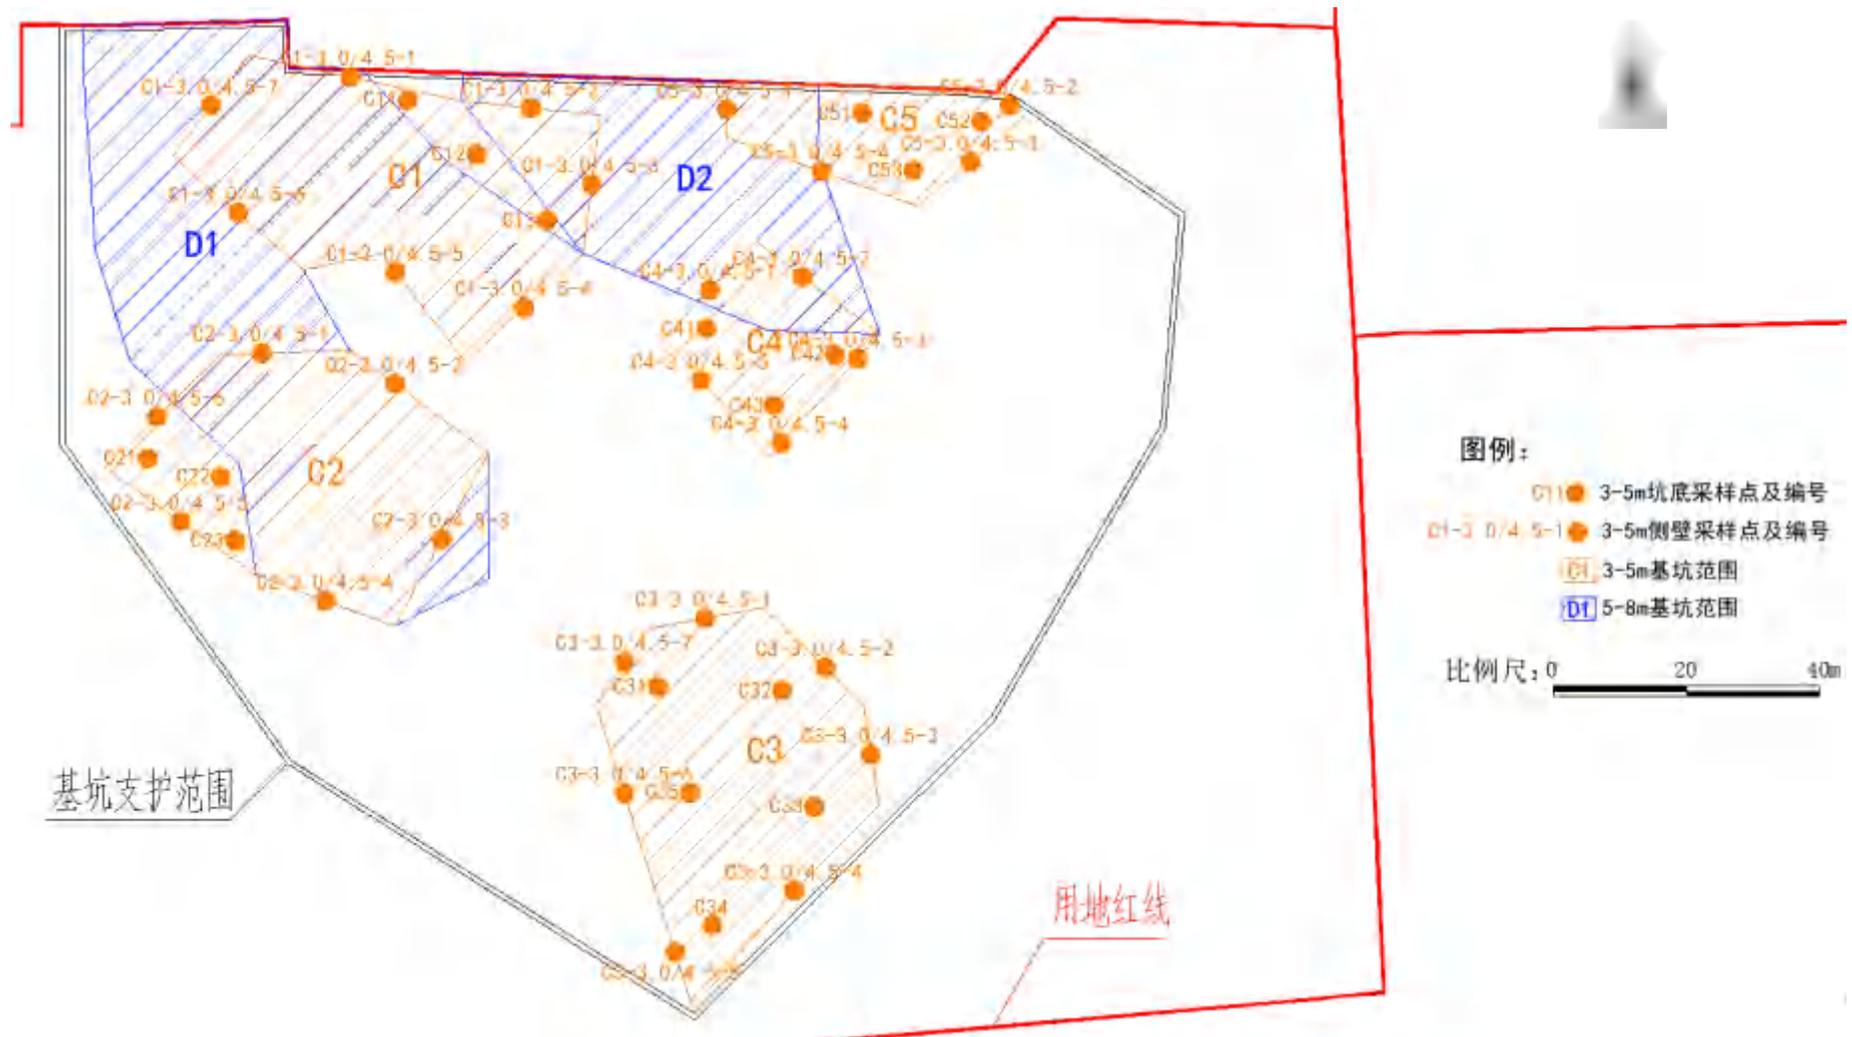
基坑侧壁和底部采样点平面布置图（3-5m）
